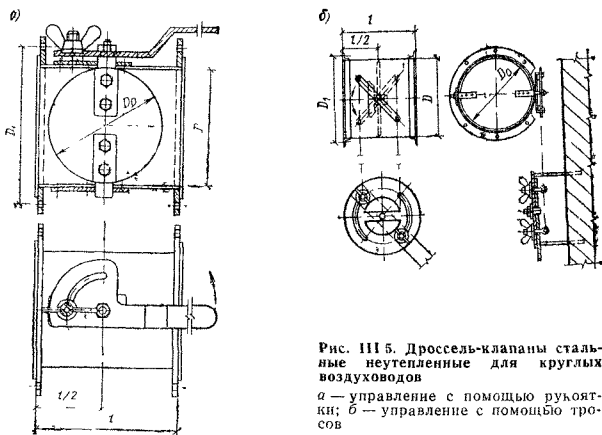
Дроссель-клапаны стальные неутепленные для круглых воздуховодов
